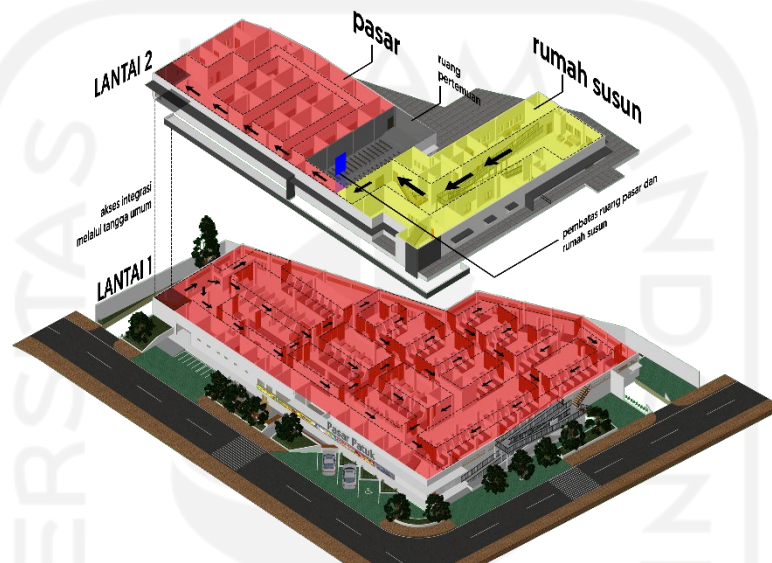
79 Tata ruang pada lantai 2 bangunan
